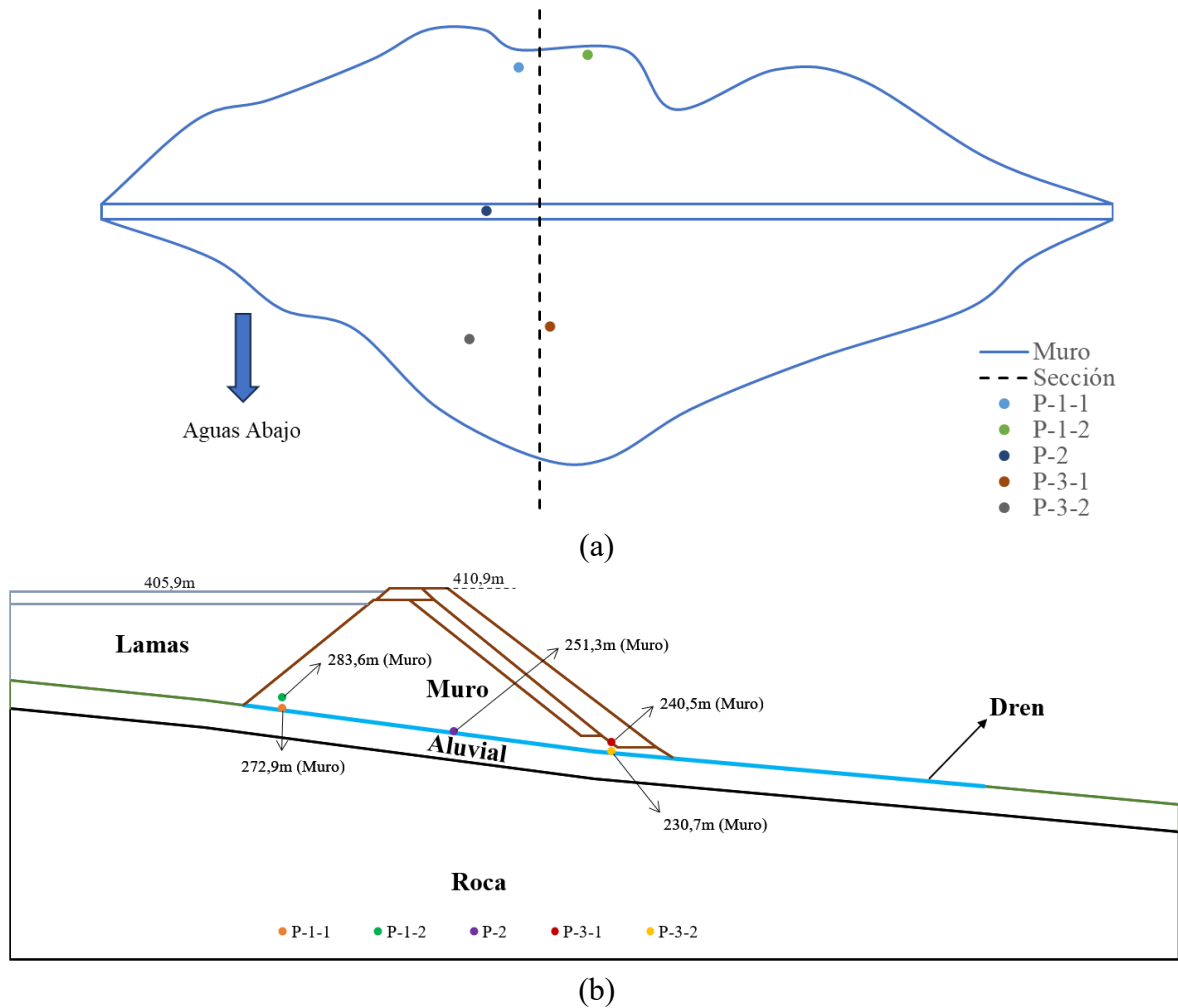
Piezómetros de monitoreo en el depósito de relaves: (a) Planta y (b) Perfil longitudinal
